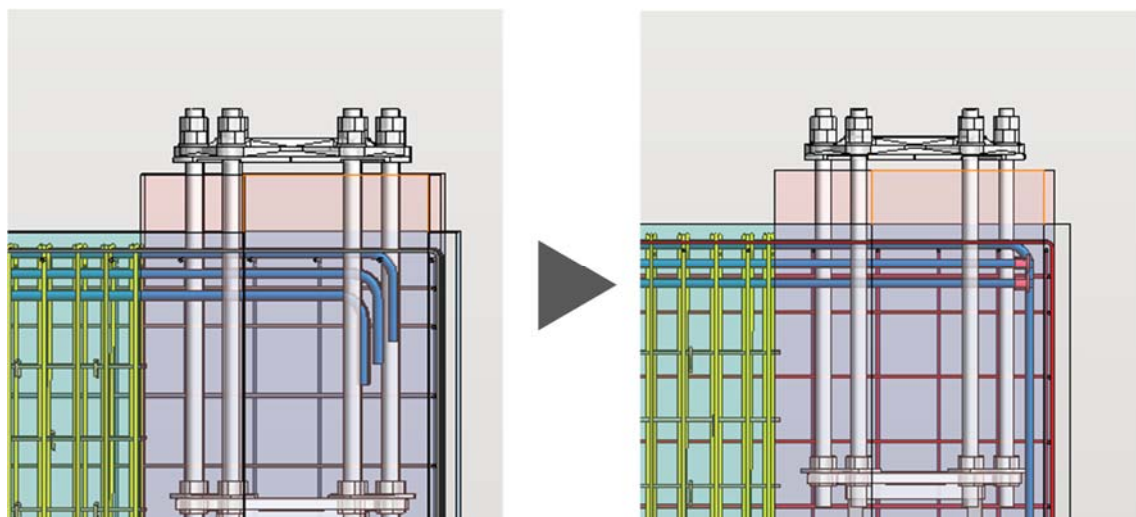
梁主筋の端部の着着（左が鉄筋 BIM モデル，右が配筋 BIM モデル）
